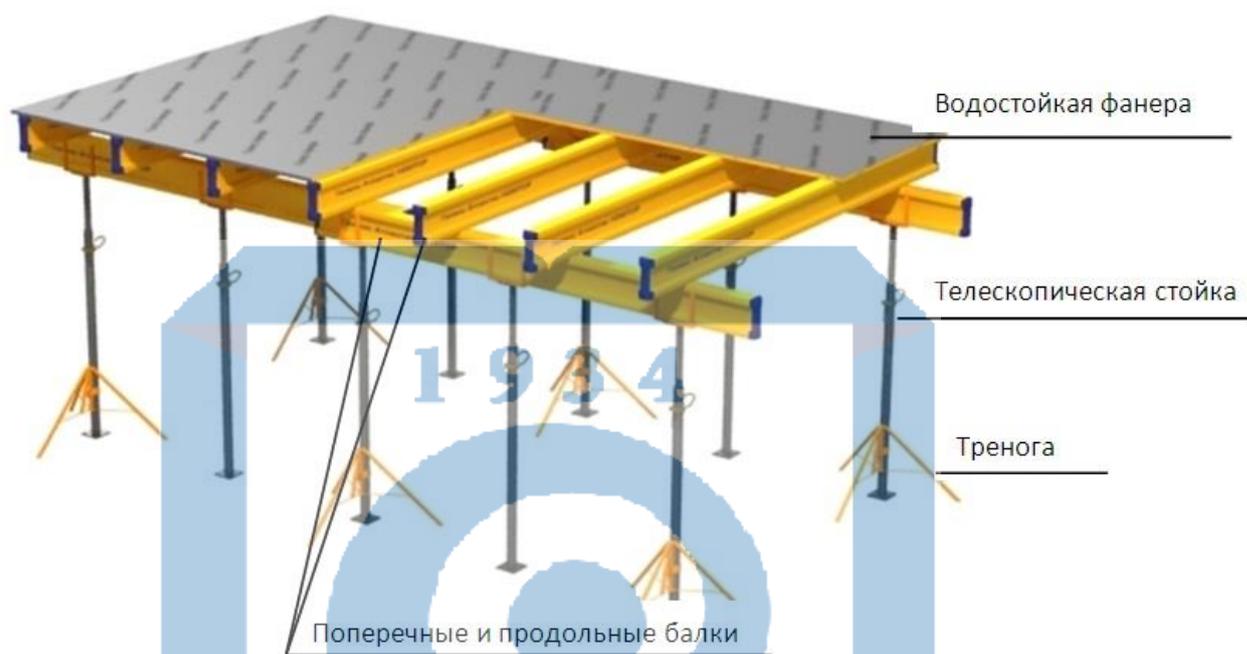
Общий вид опалубки перекрытия в сборе
